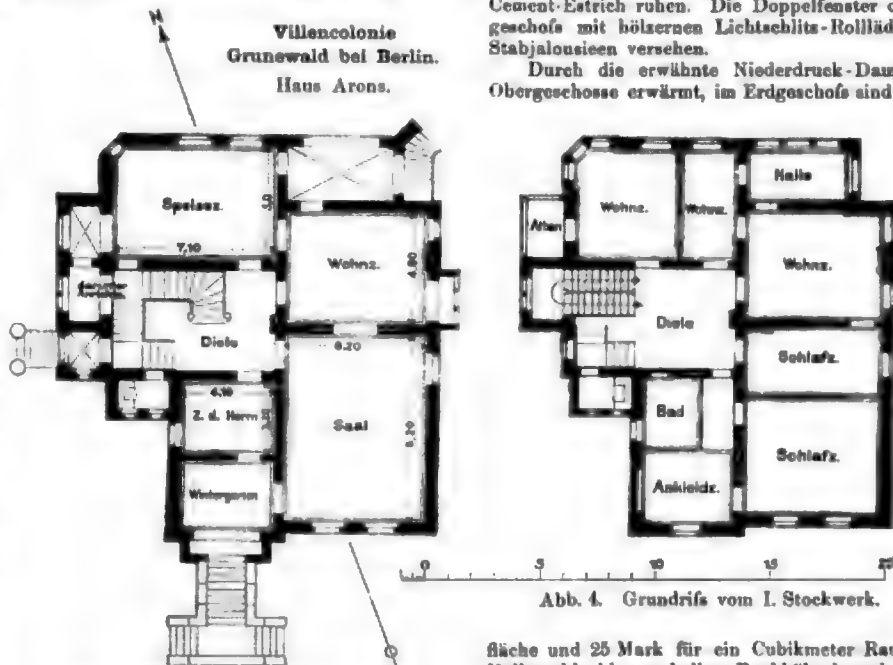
Grundriss vom Erdgeschoss.
